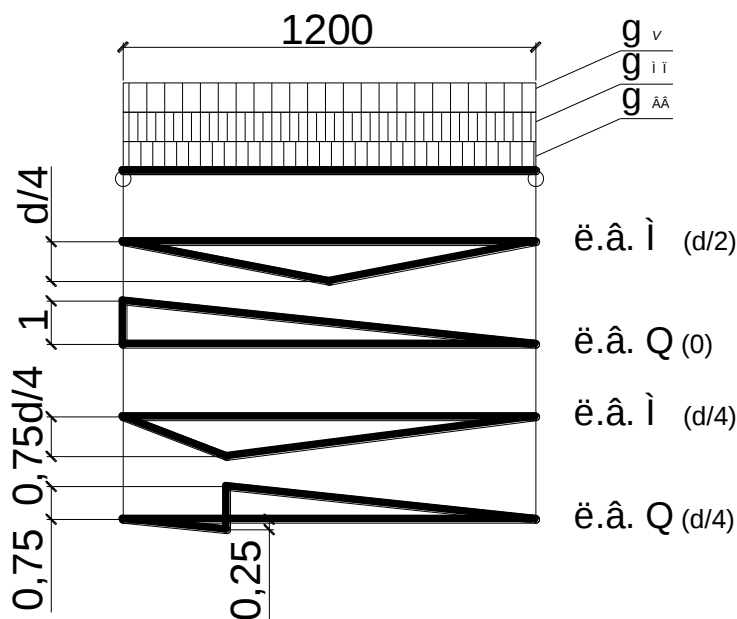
Розрахункова схема поздовжньої балки, лінії впливу M та Q
